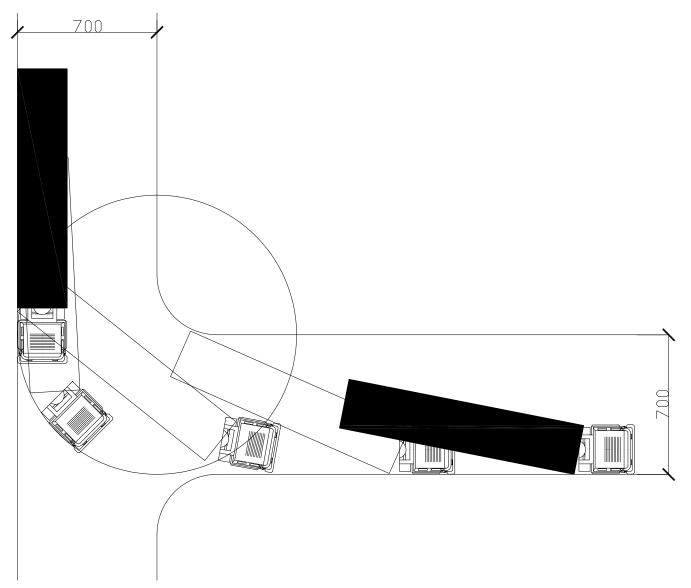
Camión con motor frontal. Fuente: www.macktrucks.com.
